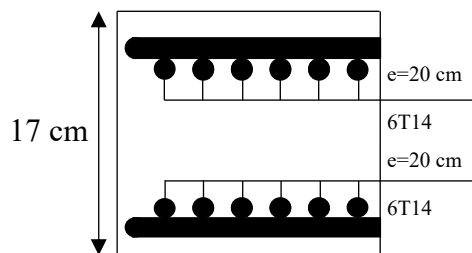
Schéma de ferrailage des balcons Type 1.
